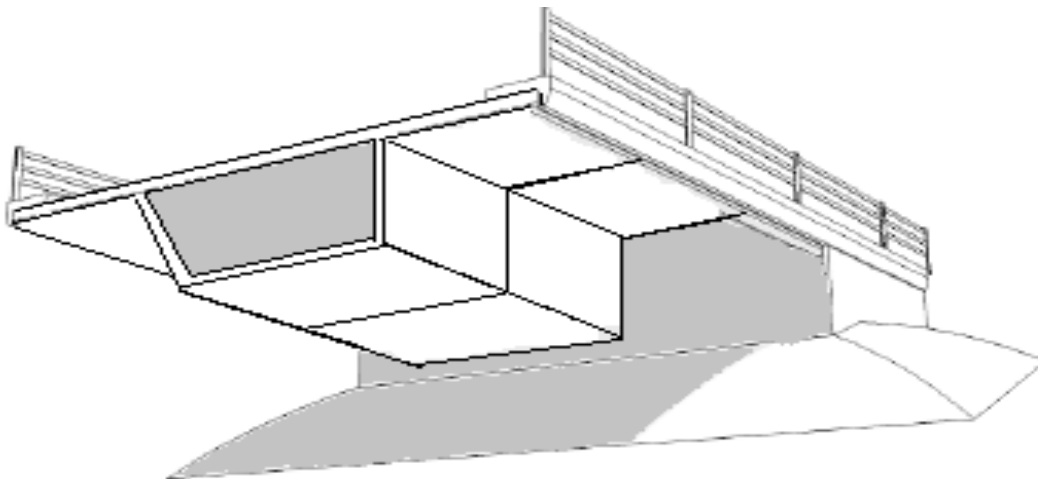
Morphologie générale d'un pont voussoirs en béton précontraint construit par encorbellements successifs préfabriqués »
